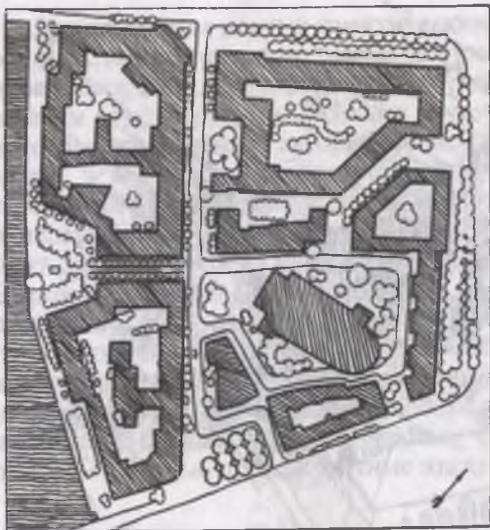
План реконструированного жилого квартала Николаи-фиртель в г. Берлине
